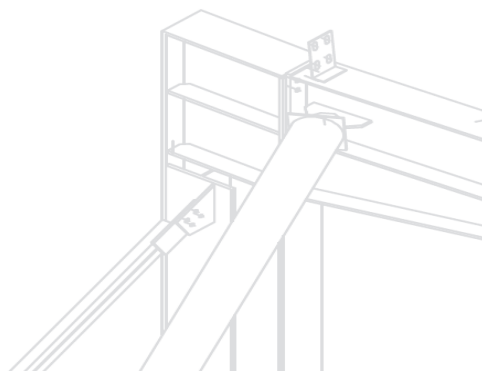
Pormenor de ligação de contraventamento entre pórticos de projeto.
